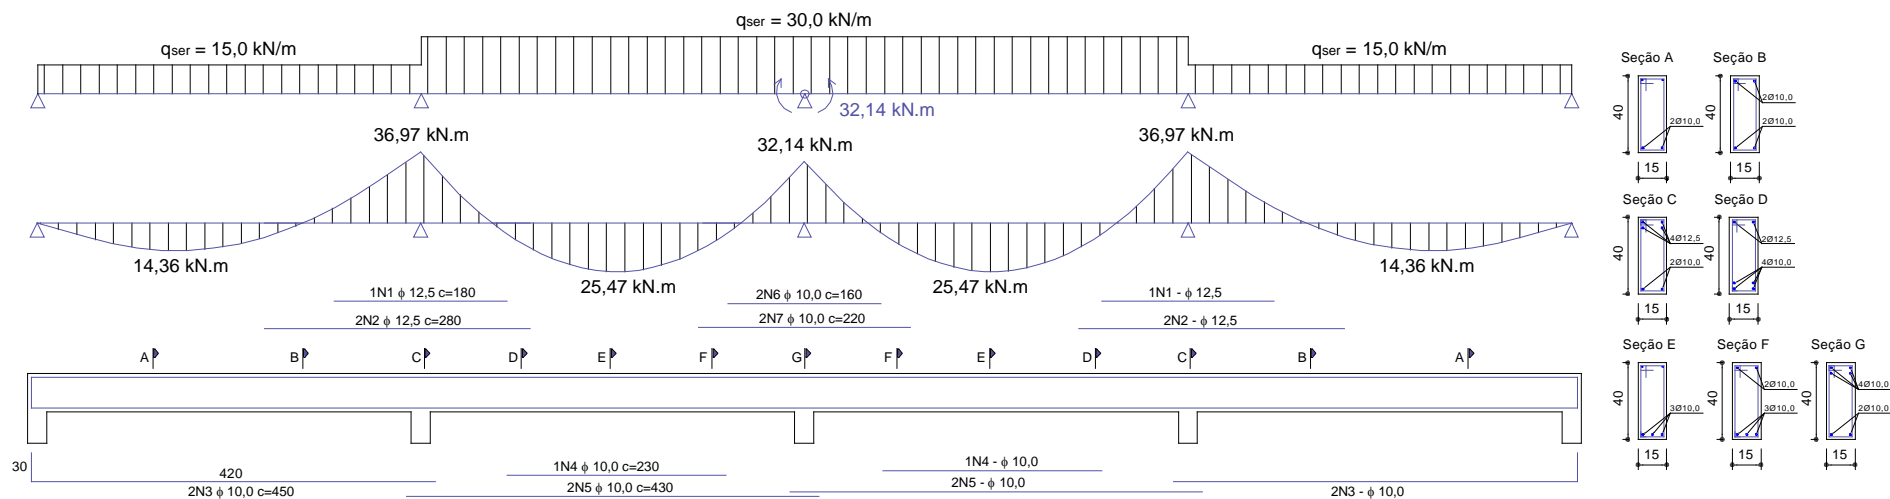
Exemplo 4B – Viga armada com redistribuição no apoio central
